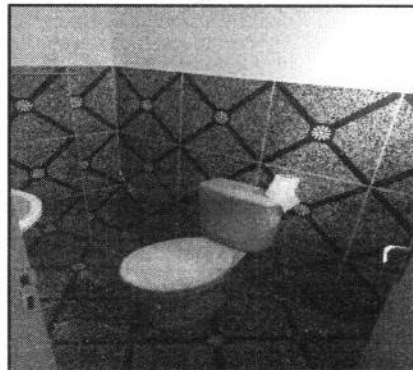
Vista da Banheiro, com destaque ao revestimento cerâmico em paredes e piso
